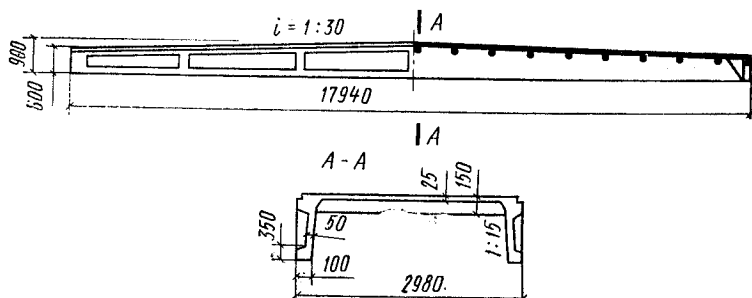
Схема ребристой плиты покрытия под малоуклонную кровлю размером 3×18 м
